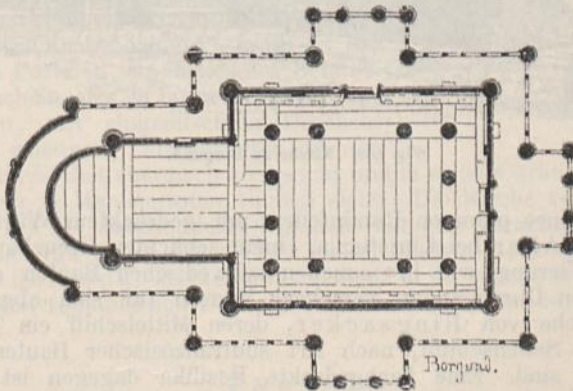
Grundriss der Kirche zu Borgund.
